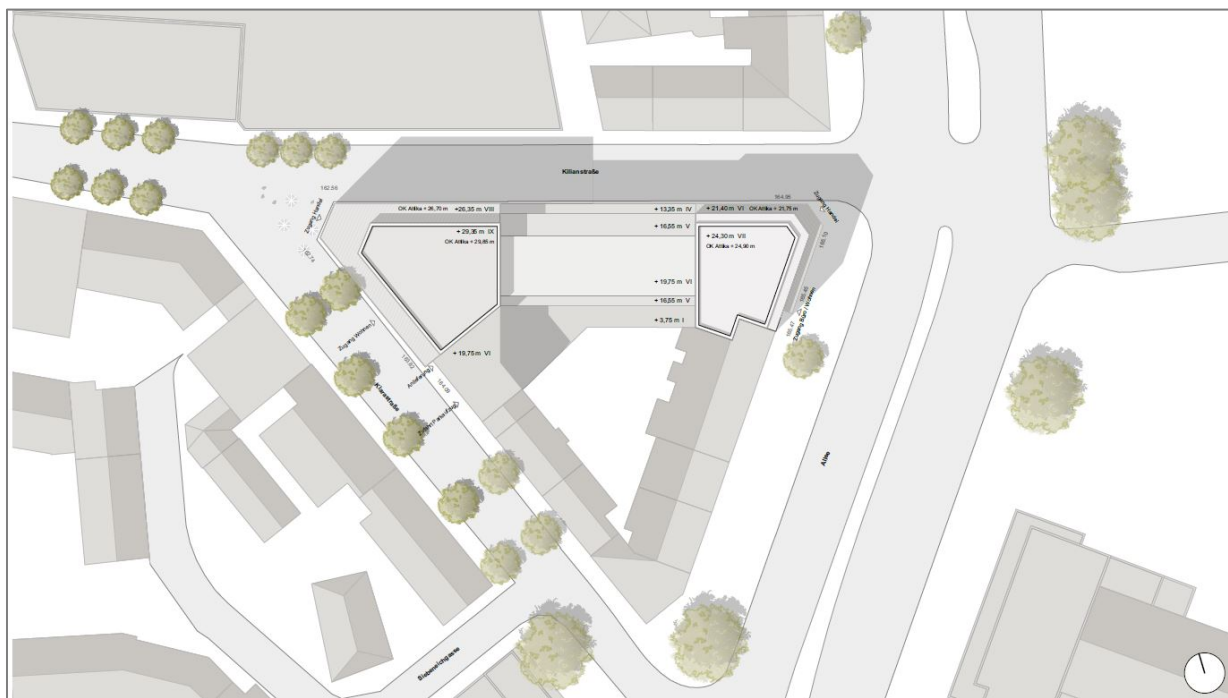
Lageplan o.M. Stand: Information Bauausschuss Juni 2018 [Quelle: Mattes Ringlewski Architekten]
